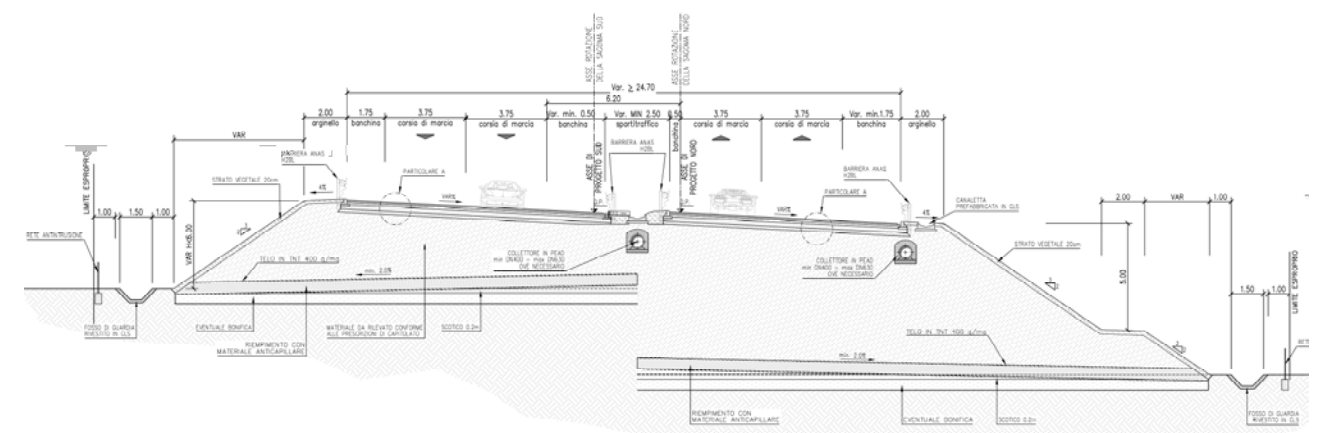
Asse principale - Sezione tipo in rilevato dell'asse principale con banche intermedie laterali
